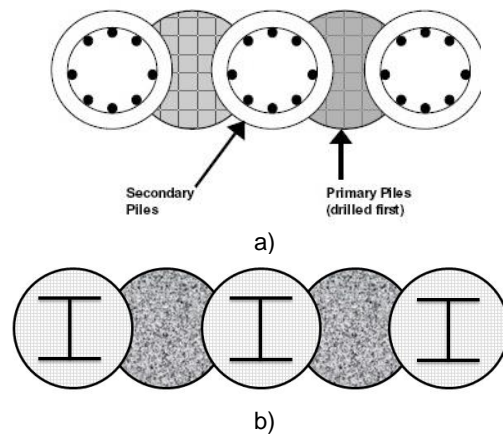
Alternativas de refuerzo en pilas secundarias, vista en planta. a) Armadura convencional. b) Perfil de acero. Lindquist y Jameson (2011).
